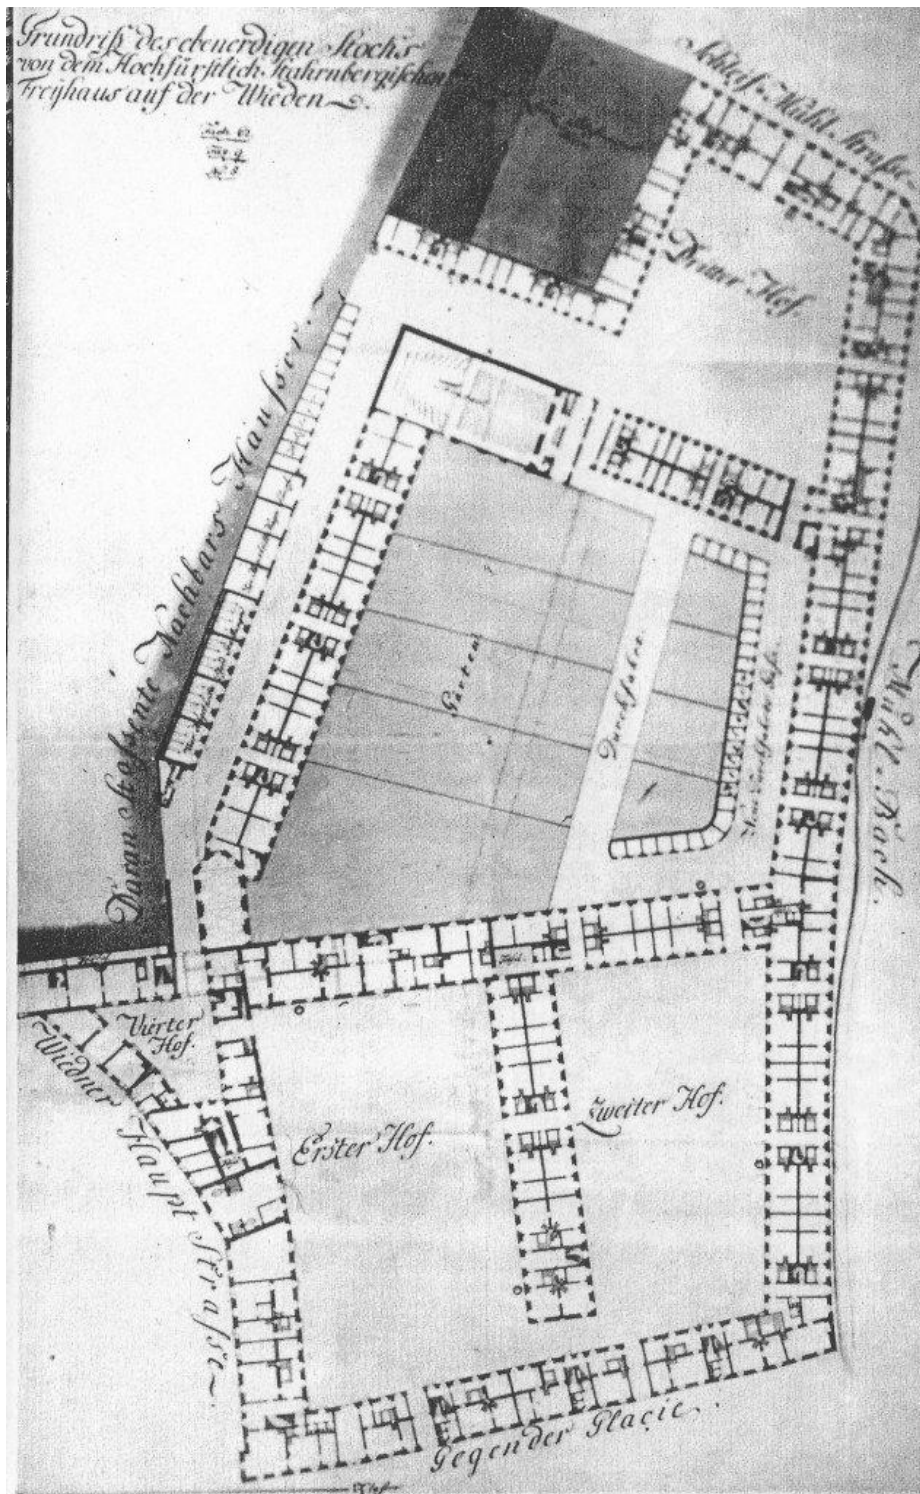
Freihaus auf der Wieden Grundriss Andreas Zach, um 1789.
